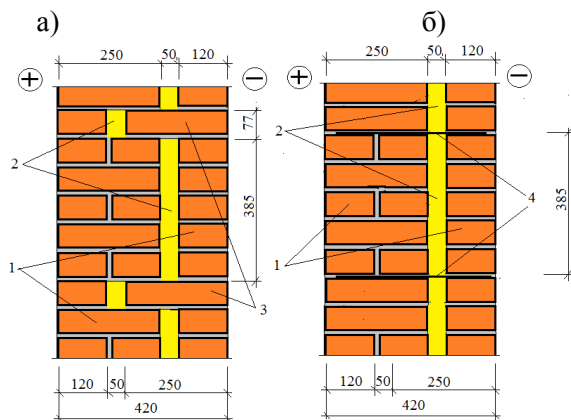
Варианты кирпичной стены с утеплителем из эффективных теплоизоляционных материалов: а – с кирпичными связями; б – с металлическими связями; 1 – кирпичная кладка; 2 – утеплитель; 3 – наружная "верста" из тычковых кирпичей; 4 – металлические связи (сетка, скоба).
